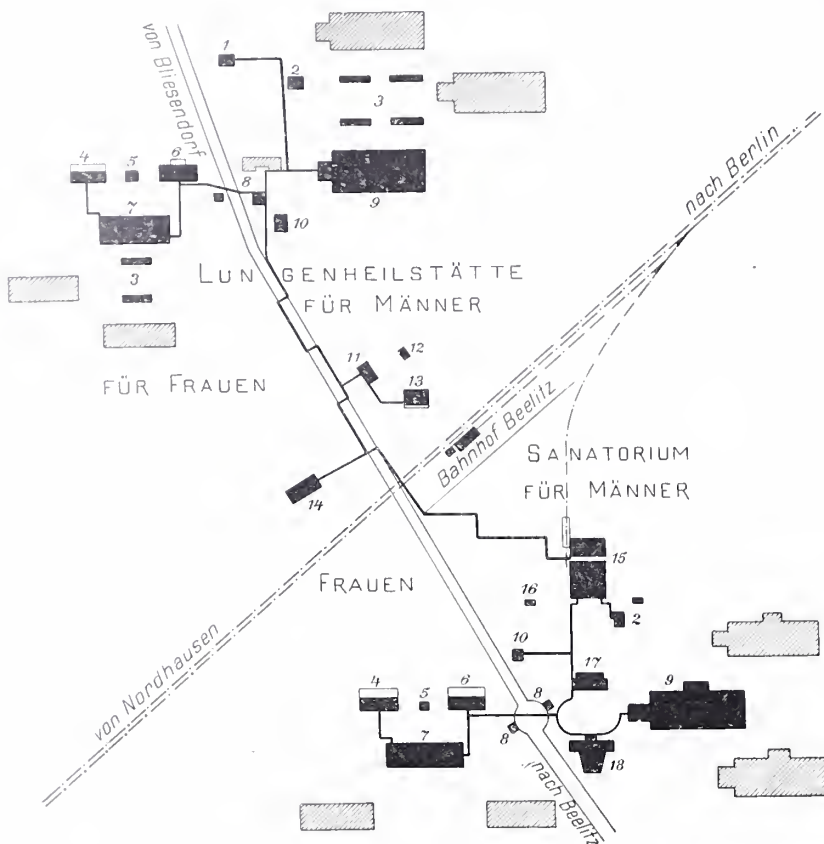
Lageplan des Fernheizwerkes Beelitz. — Massstab 1 : 10 000.
